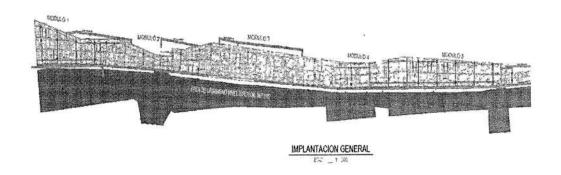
Planta General de la segunda etapa del parque lineal, objeto de ocupación del rio Magdalena
